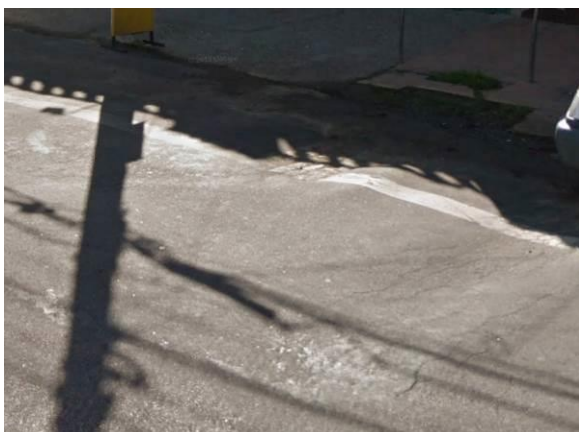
Ondulações e trincas existentes no pavimento.
